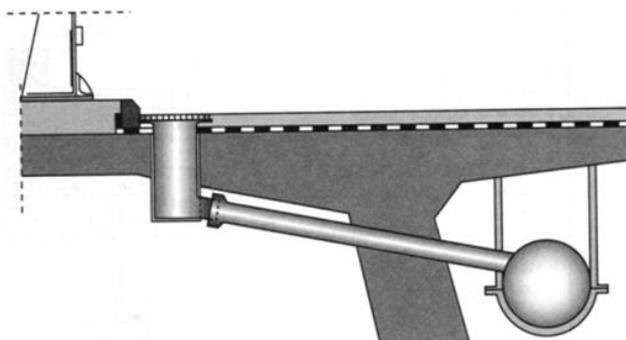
Détail d'une gargouille avec étanchéité et système d'évacuation des eaux
